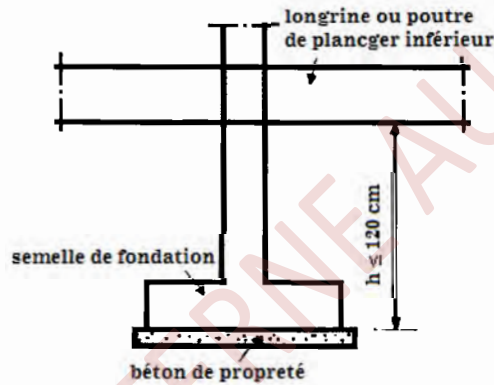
Position des longrines par rapport aux semelles de fondations
